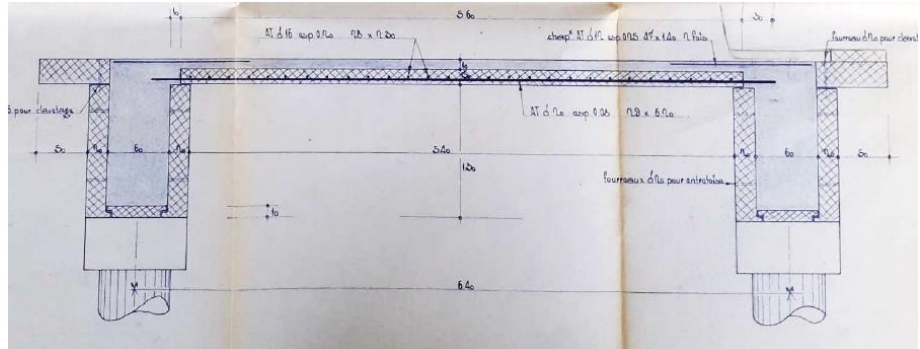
Plan de coffrage/ferrailage du tablier (source : capitainerie)
